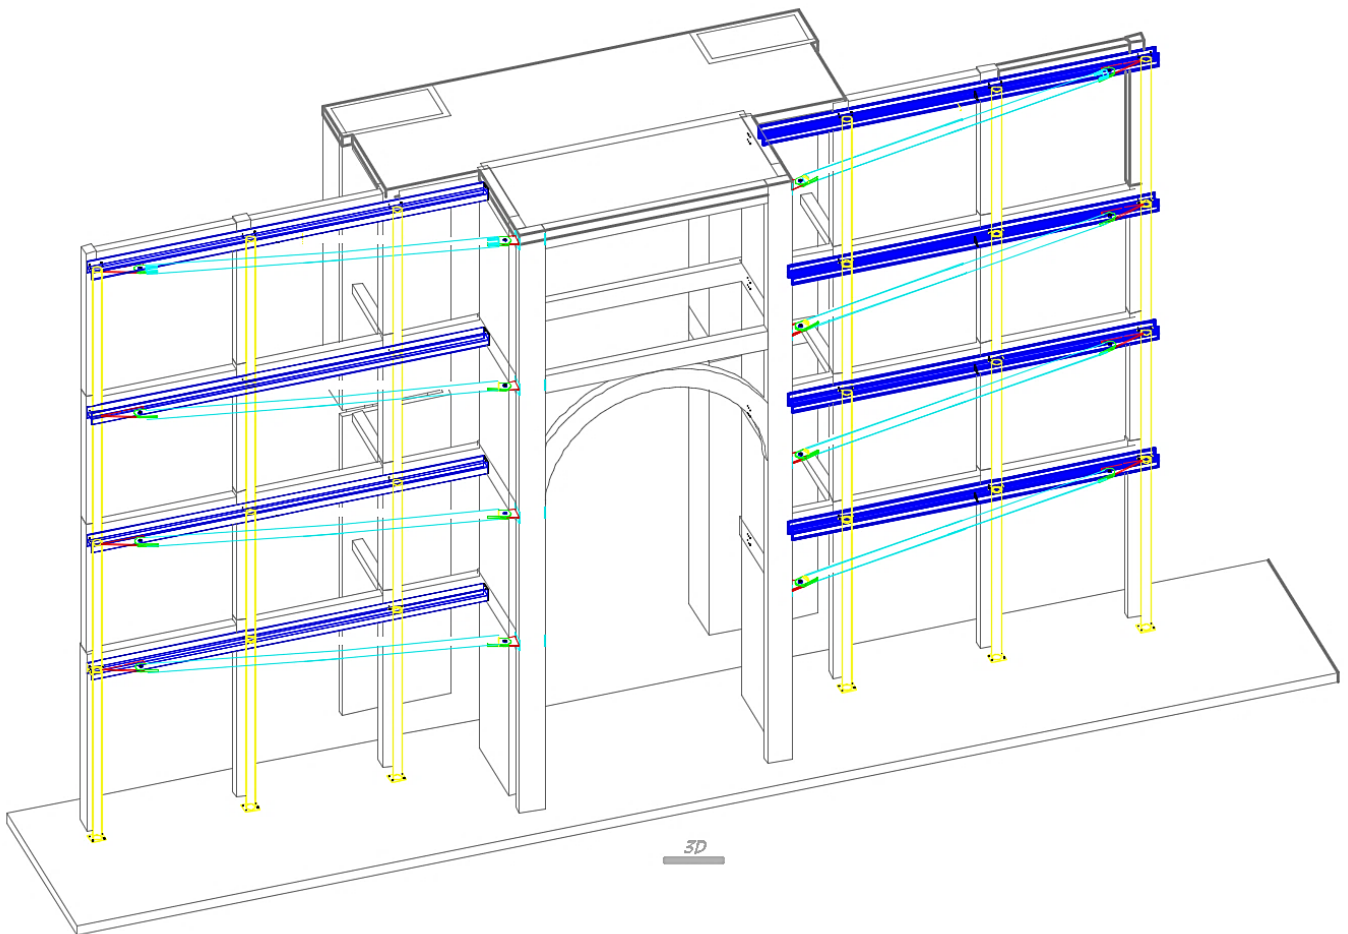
vue en 3D des tubes assemblés sur la façade existante
